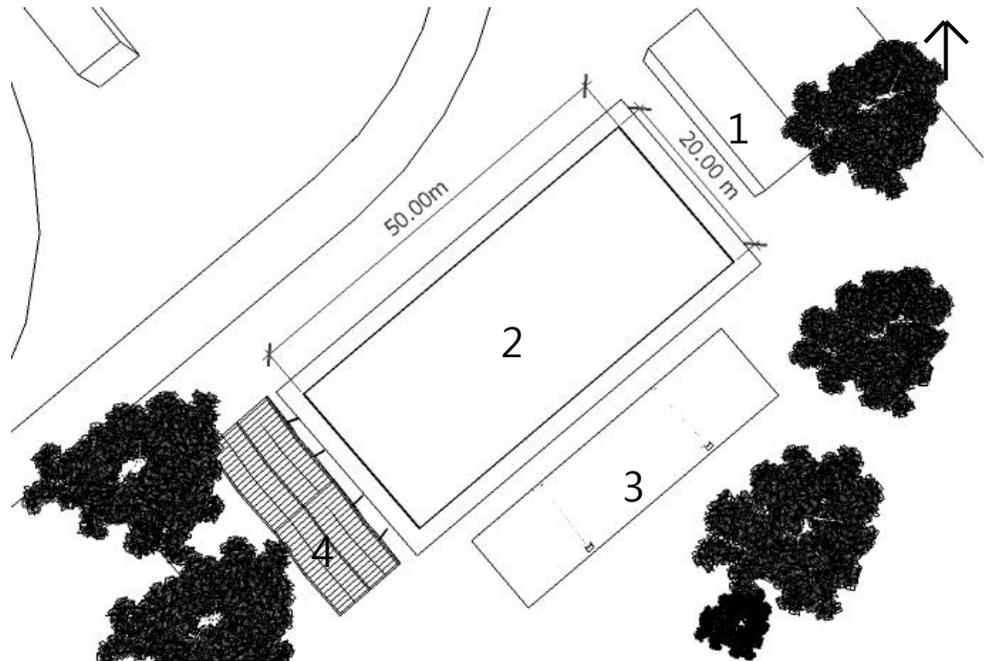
Planta de Piscina Complejo deportivo de Retalhuleu. Fuente: Elaboración propia en base en visita de campo.
